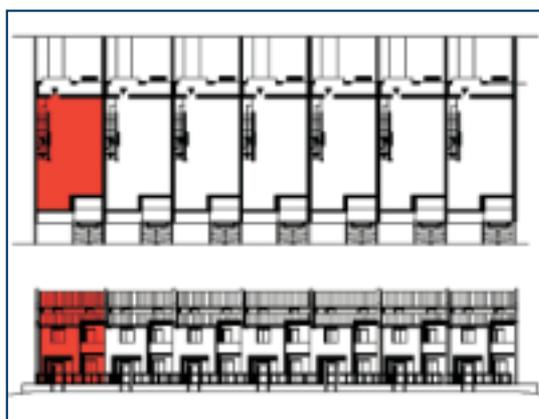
II-SA) ALLOGGI A SCHIERA AD ANGOLO - SOLAI PAVIMENTI SU TERRENO
